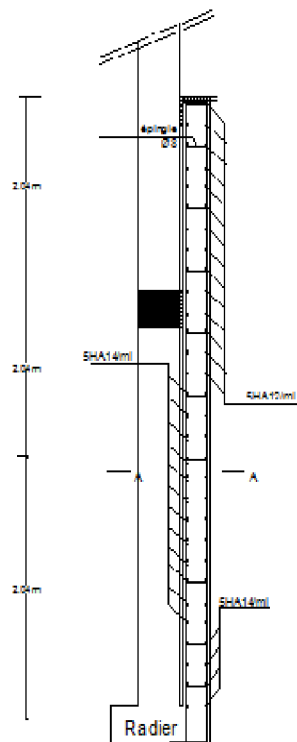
Schéma statique du ferrailage du mur plaque
